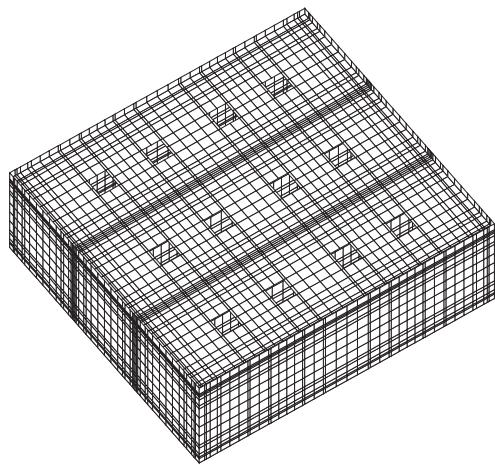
ガスタービン発電設備軽油タンク室 三次元モデル図
